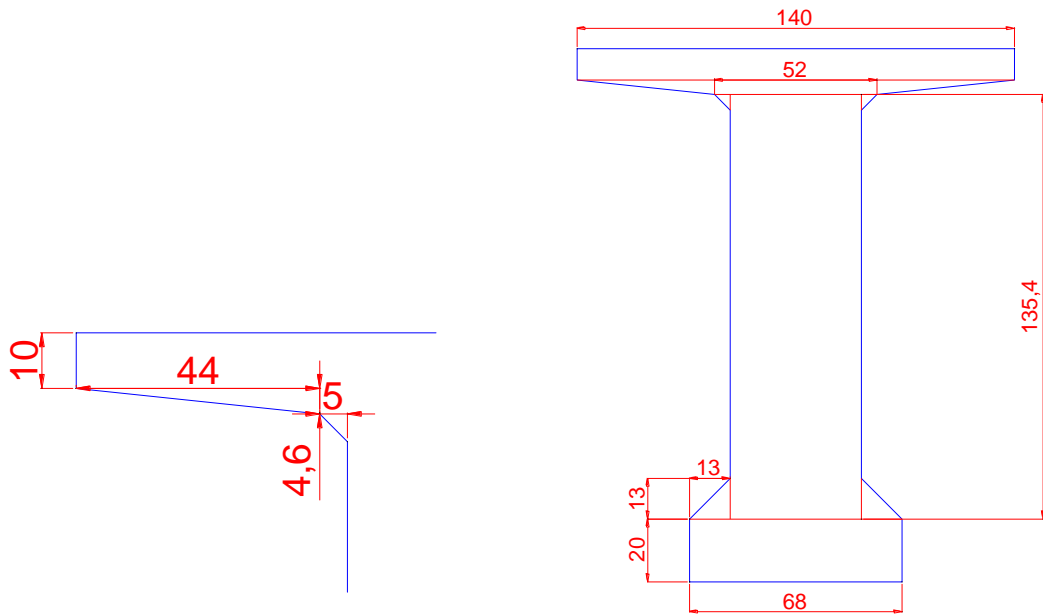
Coupe transversale de la poutre d'about à mi travée.
